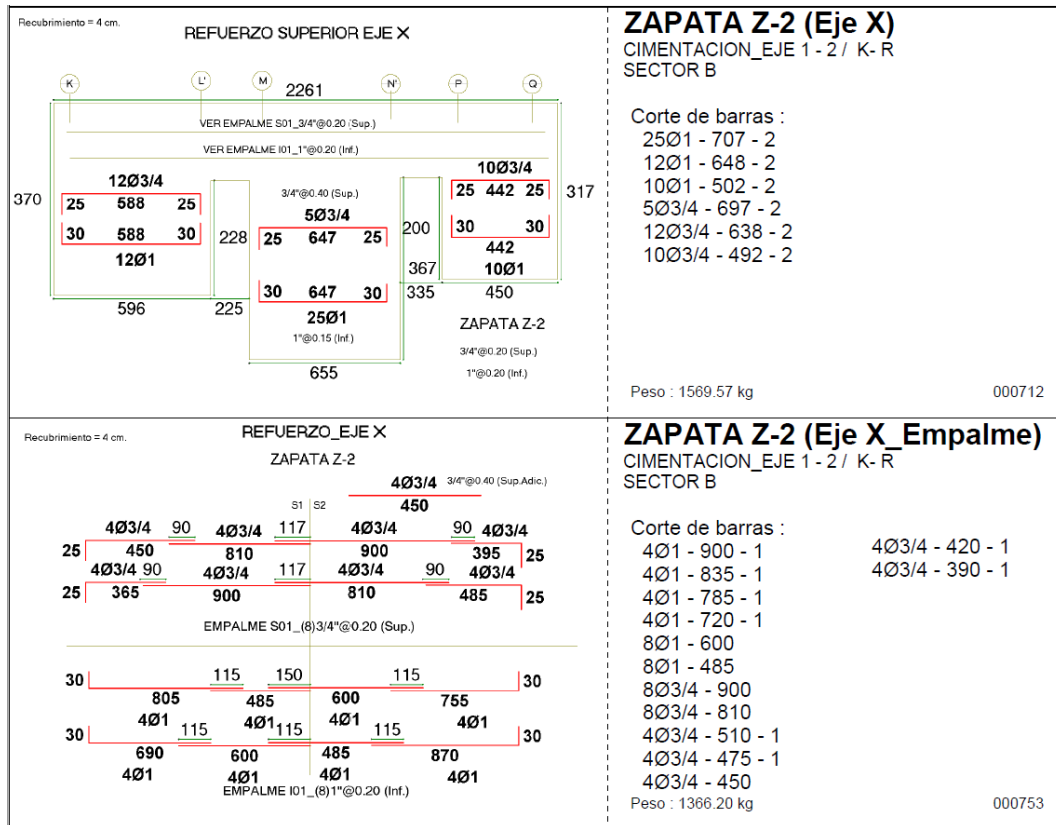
Planilla 4576_CIMENTACION_EJE 1 - 2_ K- R _ SECTOR B.REV-3.
